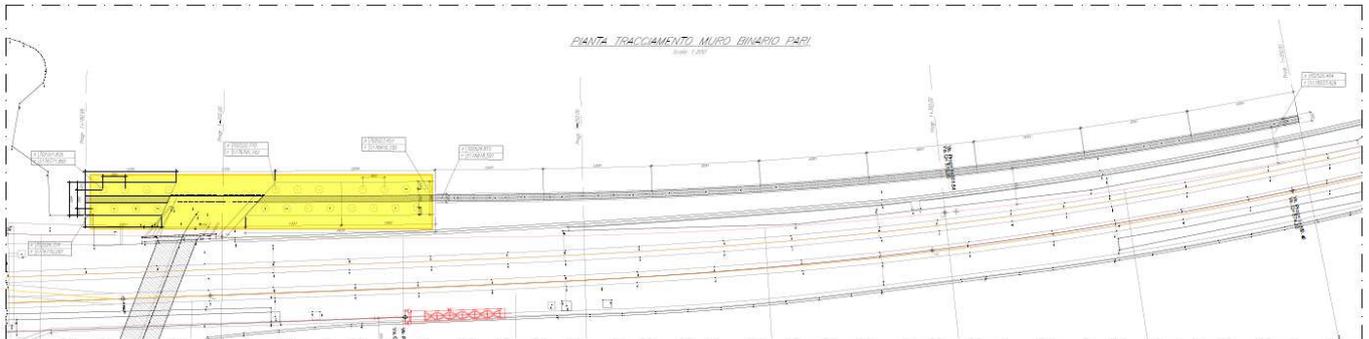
Individuazione Muro di scavalco in c.a. su fondazioni profonde – Planimetria
